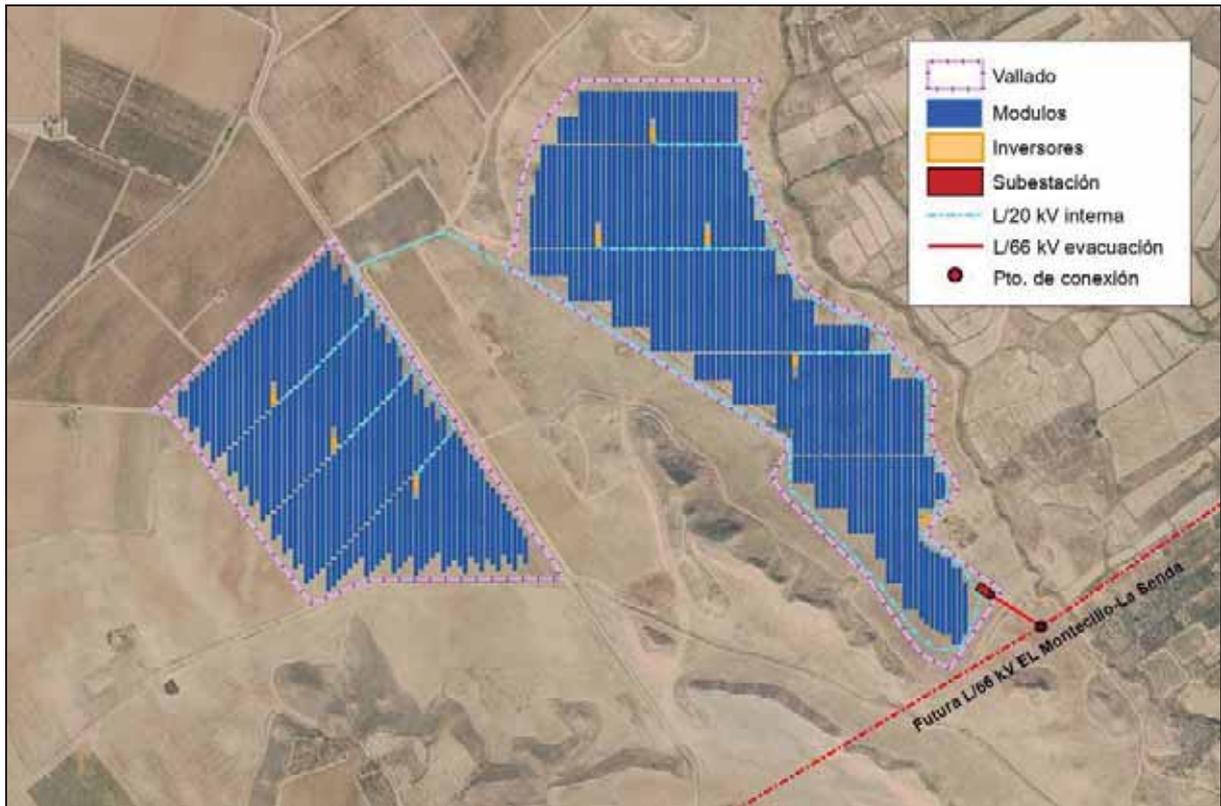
Implantación definitiva para instalación de planta solar fotovoltaica y línea eléctrica de evacuación
